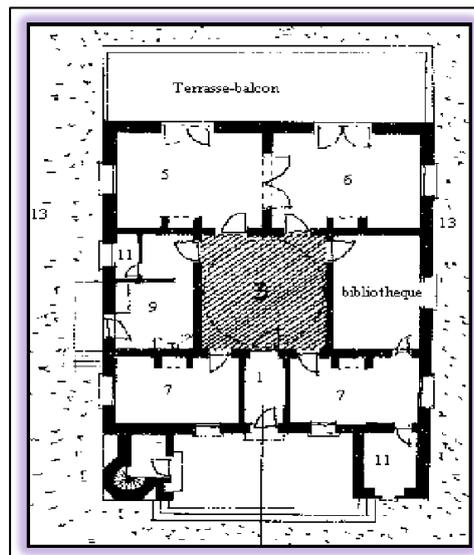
Plan Rez-de-chaussée d'une villa coloniale à Tunis
